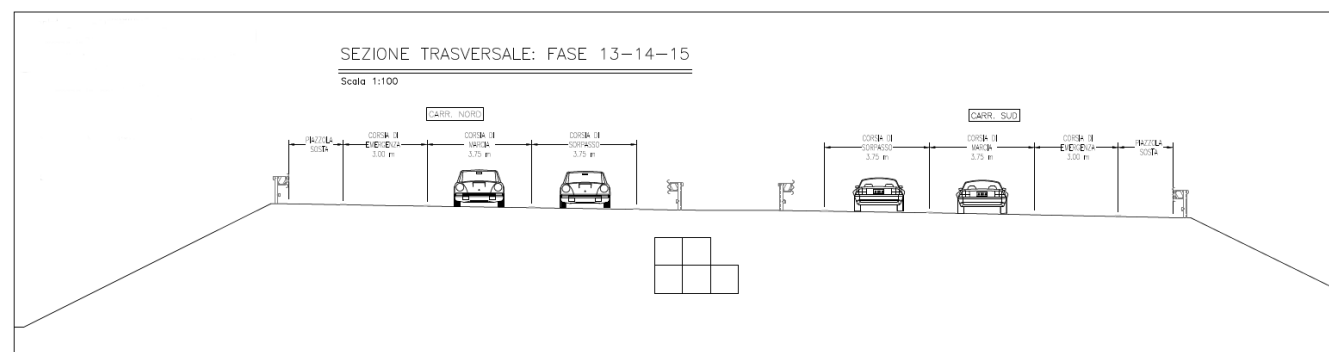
Sezione trasversale: Fasi 13 e 14
